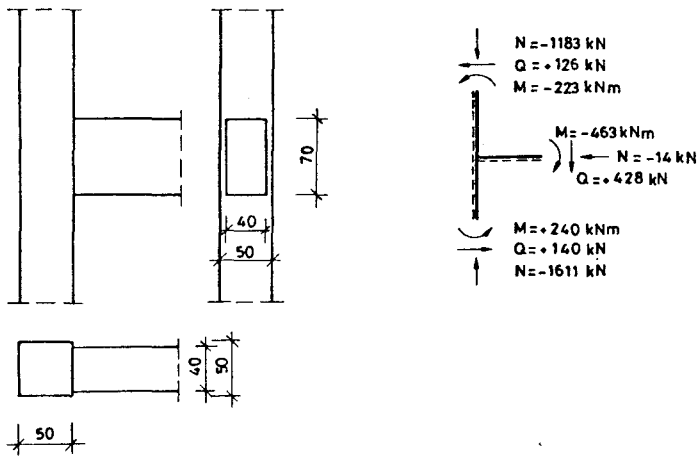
Rahmenendknoten mit hohem Bewehrungsgehalt
